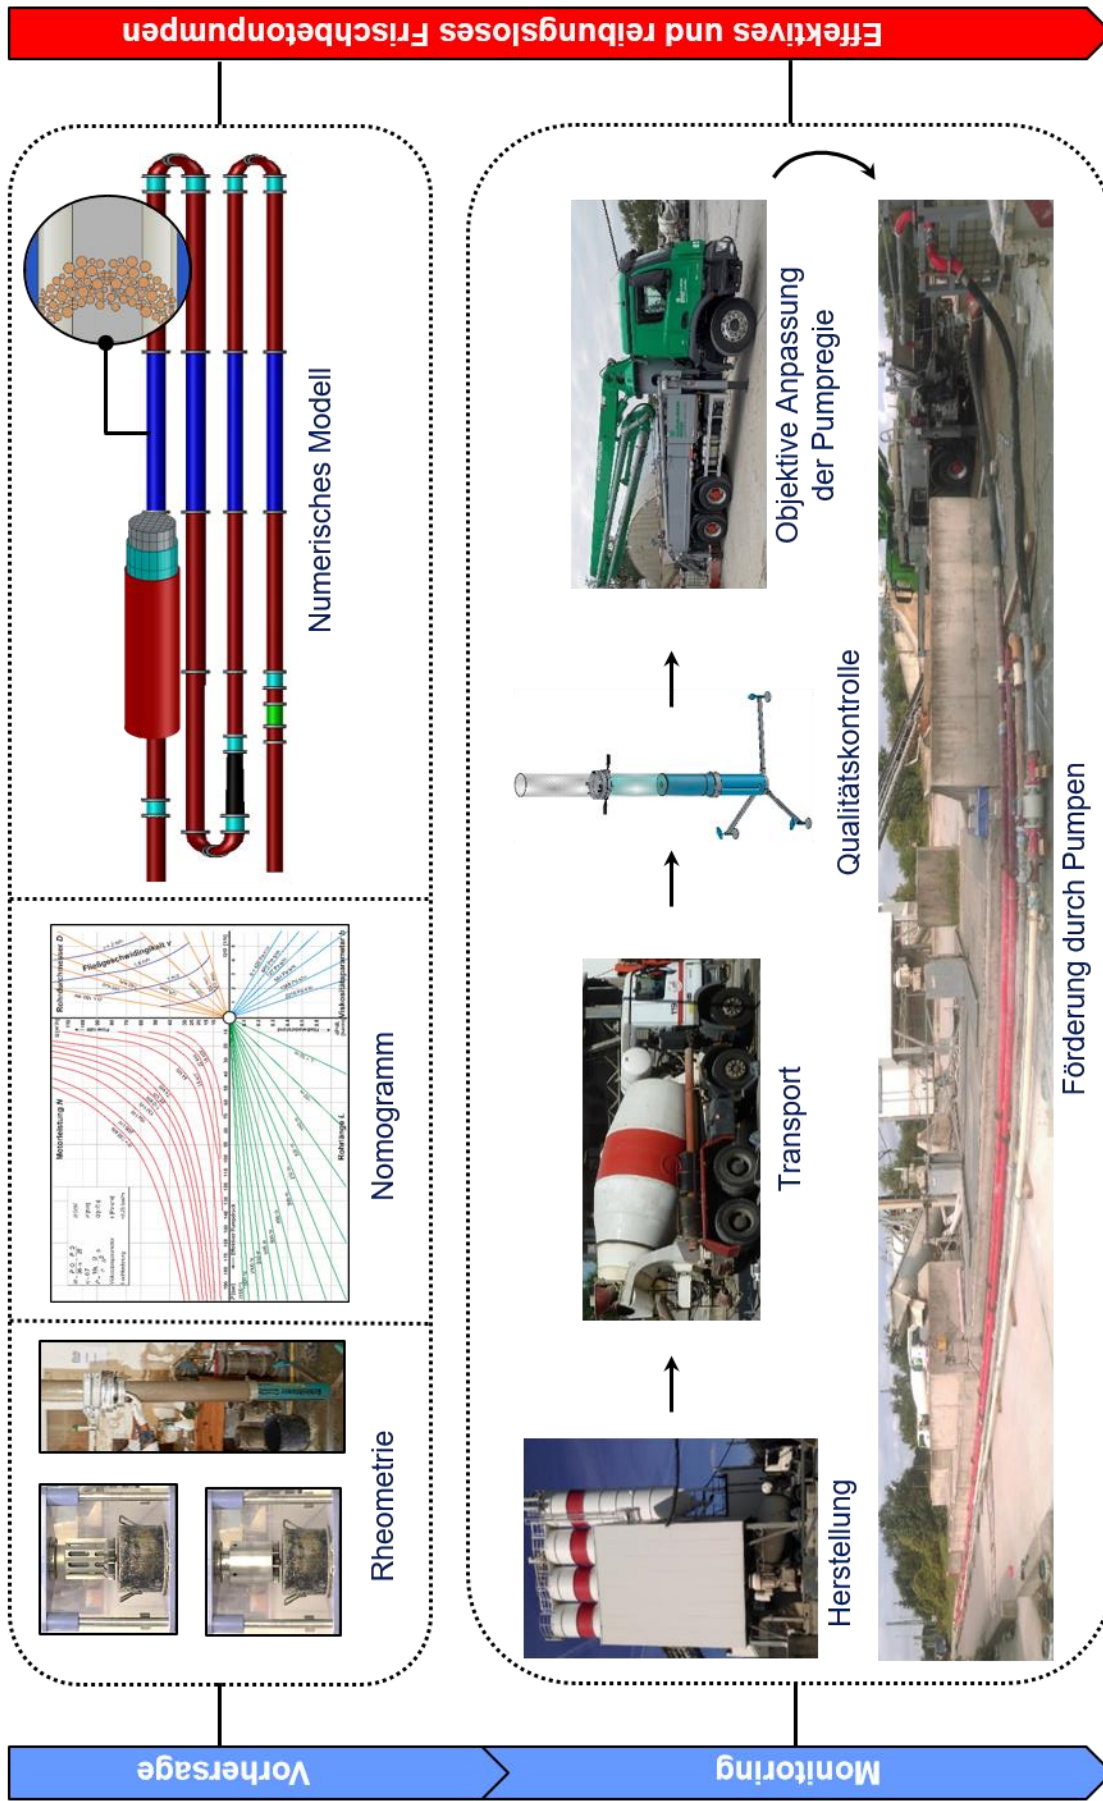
In-situ Betonrheologie-Überwachung im Hinblick auf Einbringprozesse von Beton.
